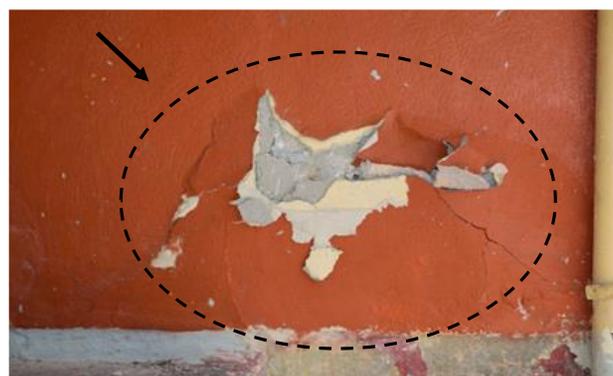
Daño en muro de concreto-Escuela primaria Pedro Sainz de Baranda
